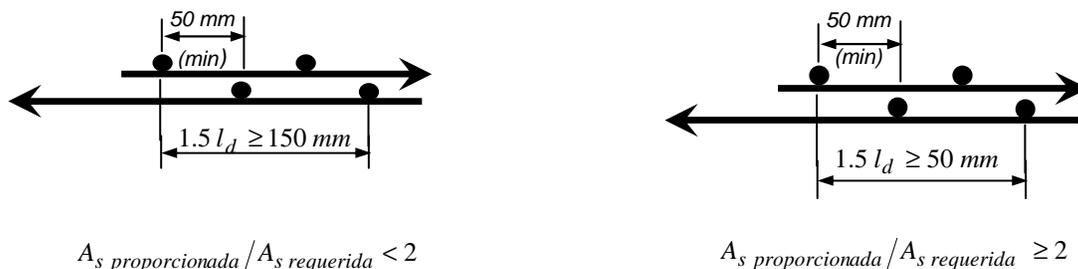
Detalle de traslape para malla de refuerzo con alambre liso
